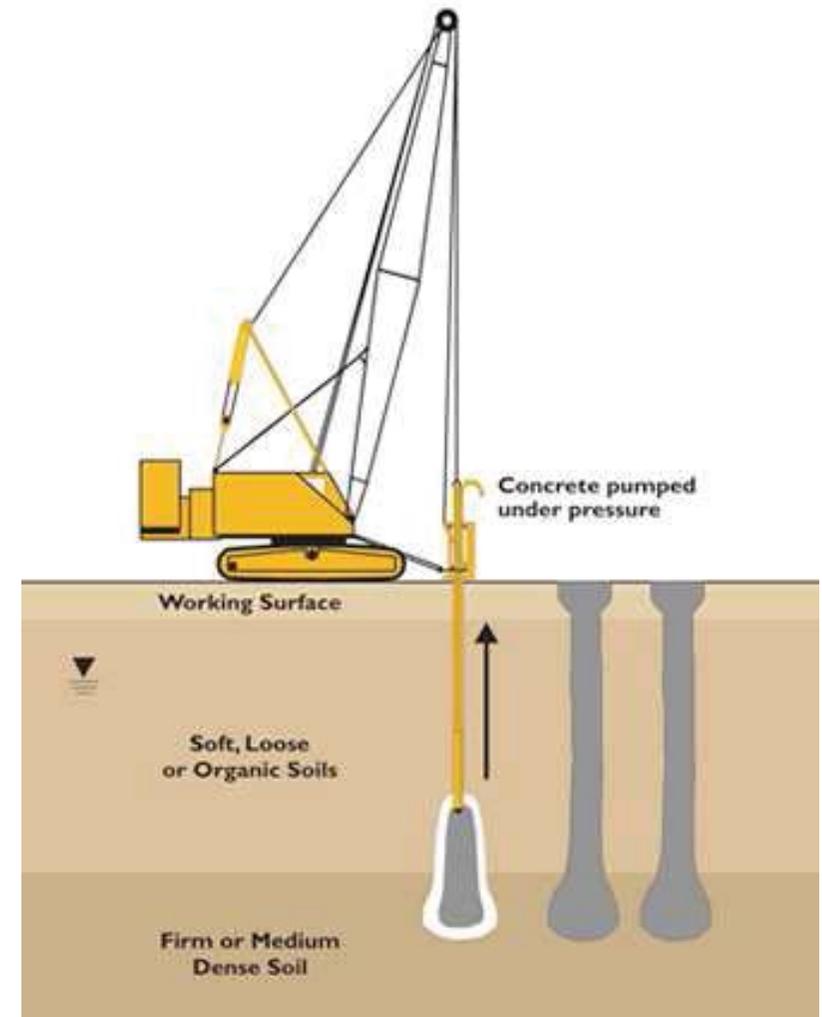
Esquema Google. Proceso: construcción de pilotes de compactación in situ. Excavación, instalación de armado de acero y llenado de la perforación.
